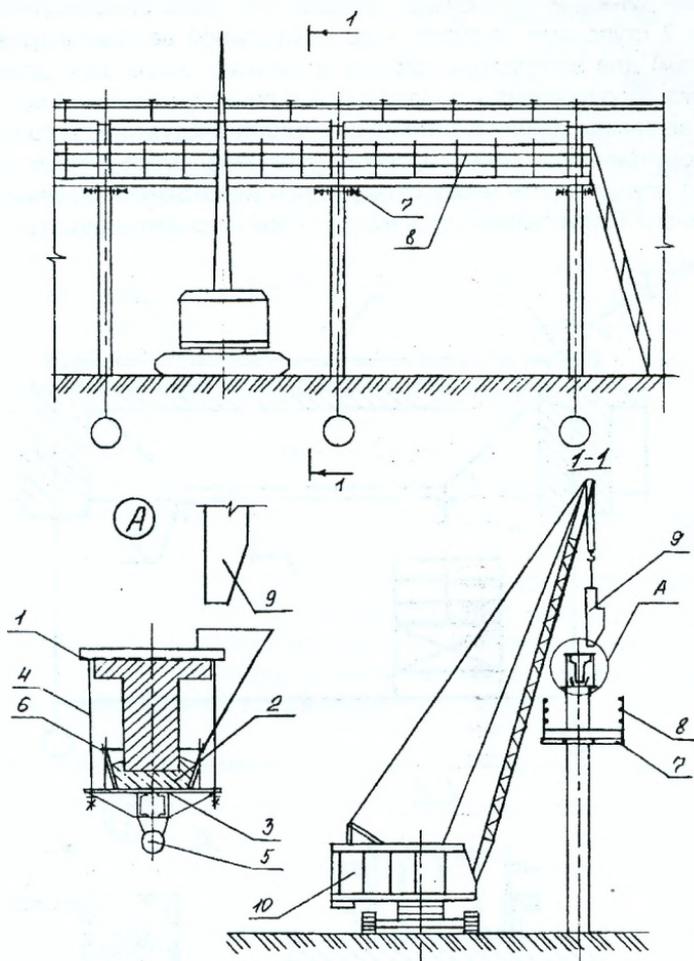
Схема усиления подкрановой балки с креплением рабочих площадок на металлических консолях:
